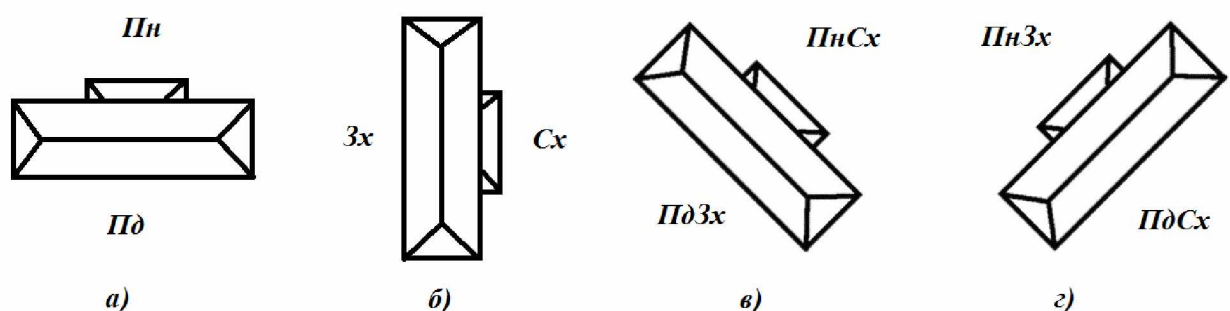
Варіанти розташування головного фасаду будівлі, застосовані у моделюванні
